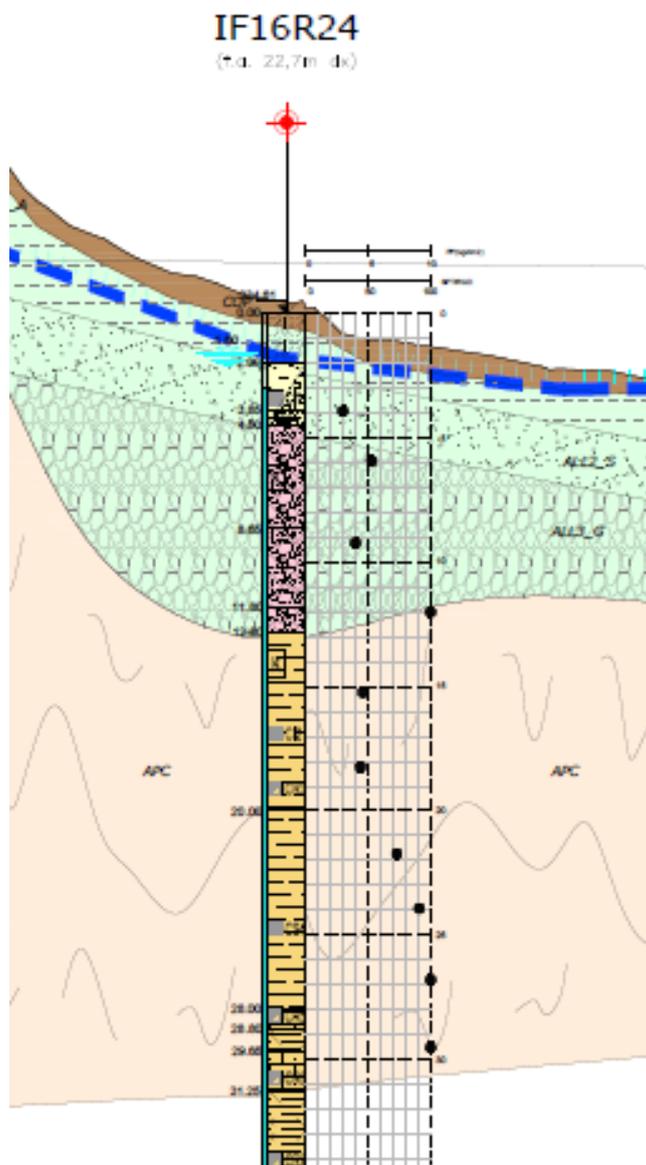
Stralcio profilo geotecnico tratta di riferimento
